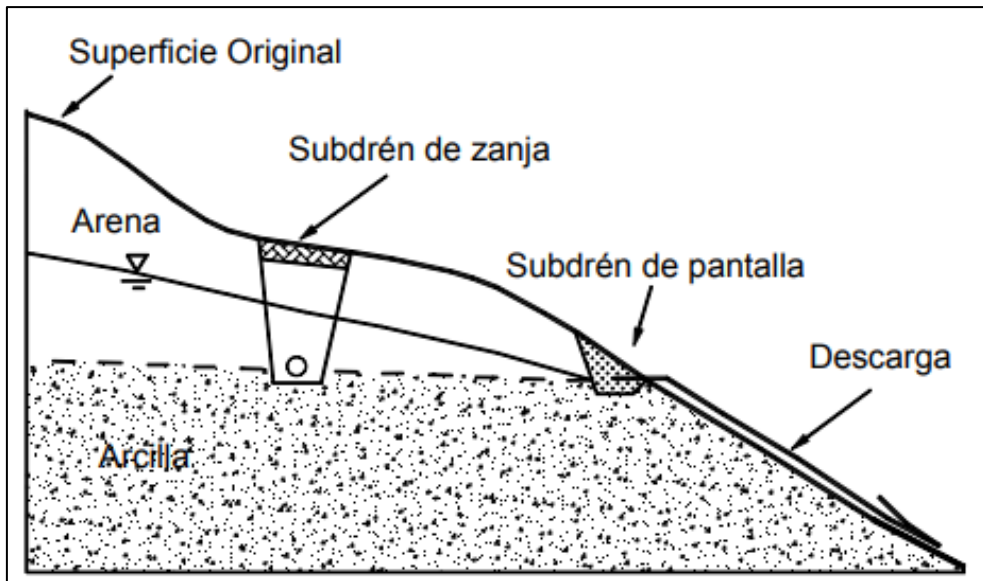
Sistemas de subdrenaje (Suárez, 1998).
